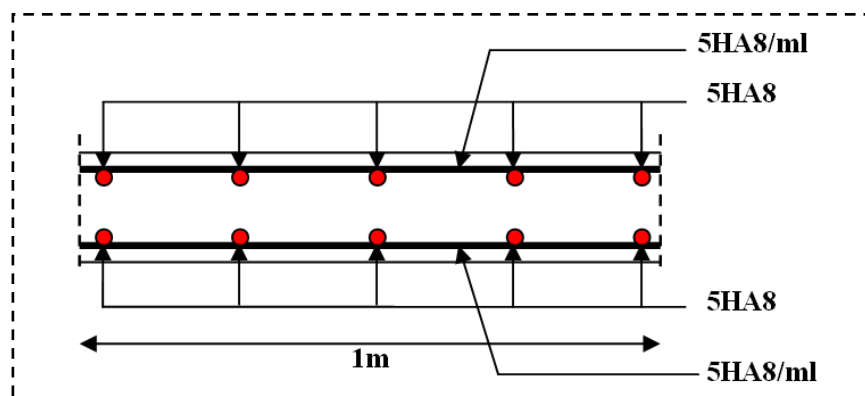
Schéma de ferrailage de la dalle pleine 3^{ème} type
